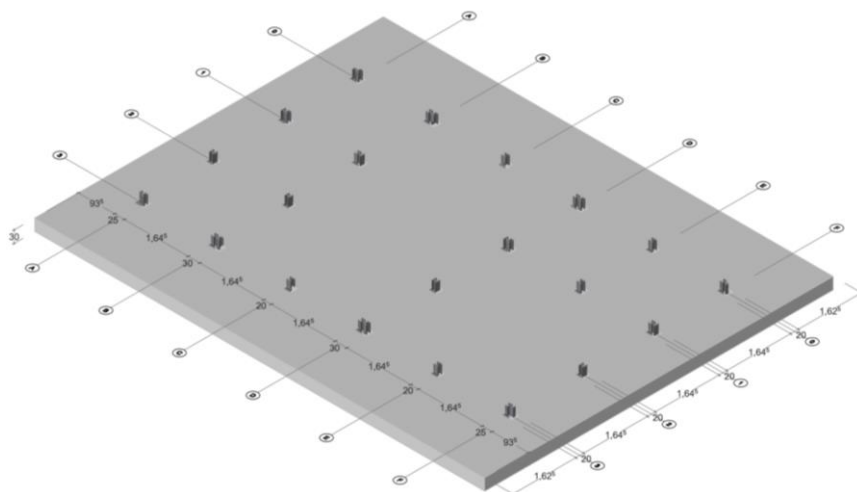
Cimentación directa tipo losa con su distribución de columnas
